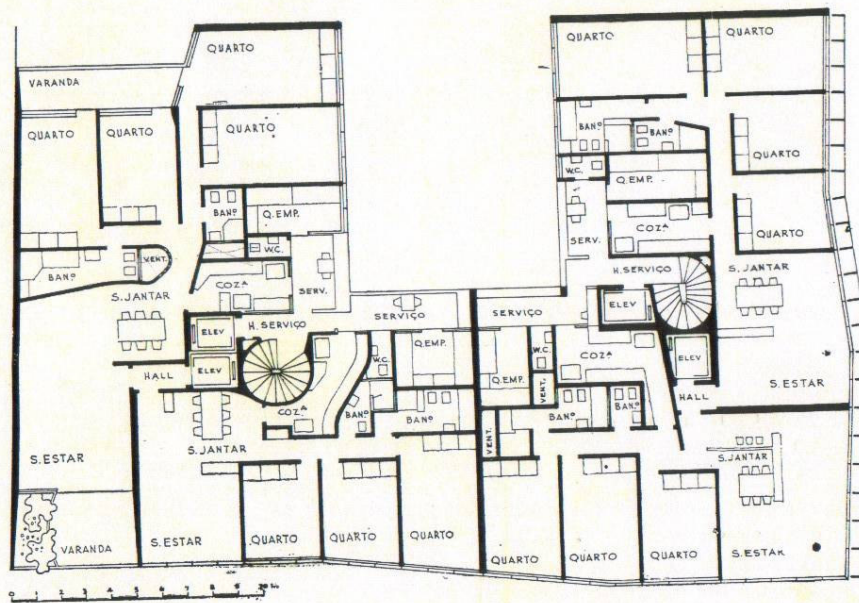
Planta baixa pav. tipo edifícios Finúzia e Dona Fátima
